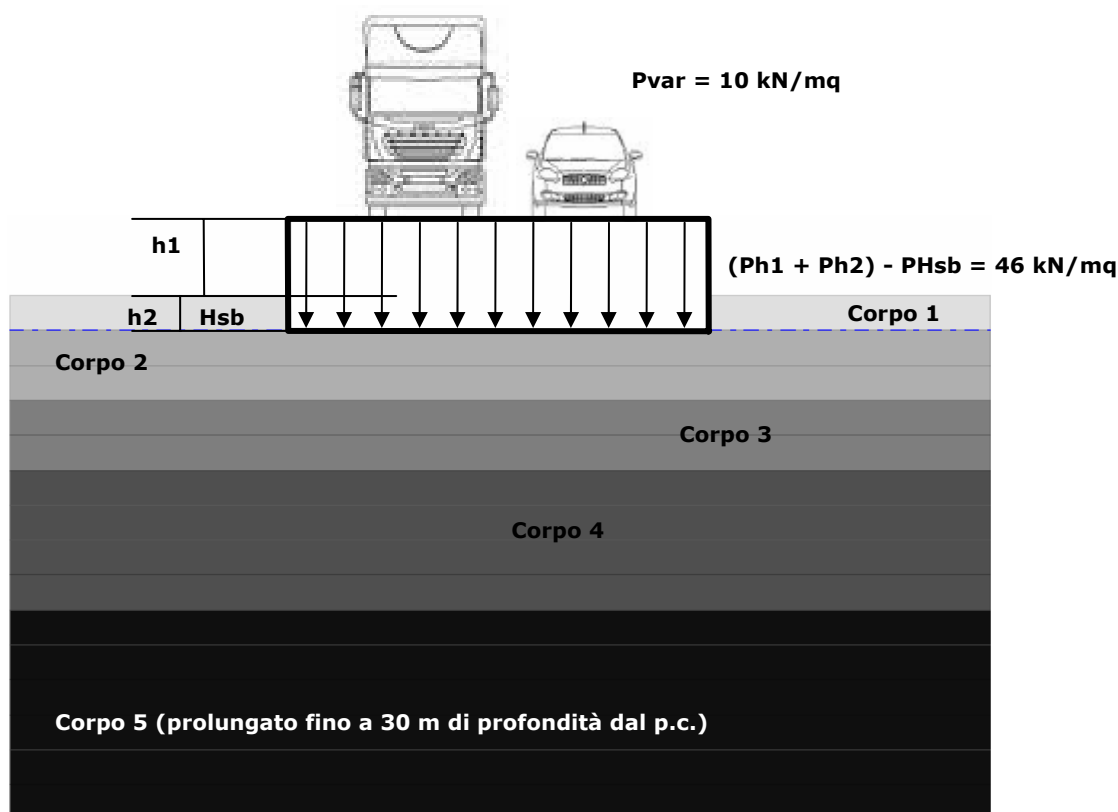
Assegnazione dei carichi sul piano di fondazione del rilevato.
